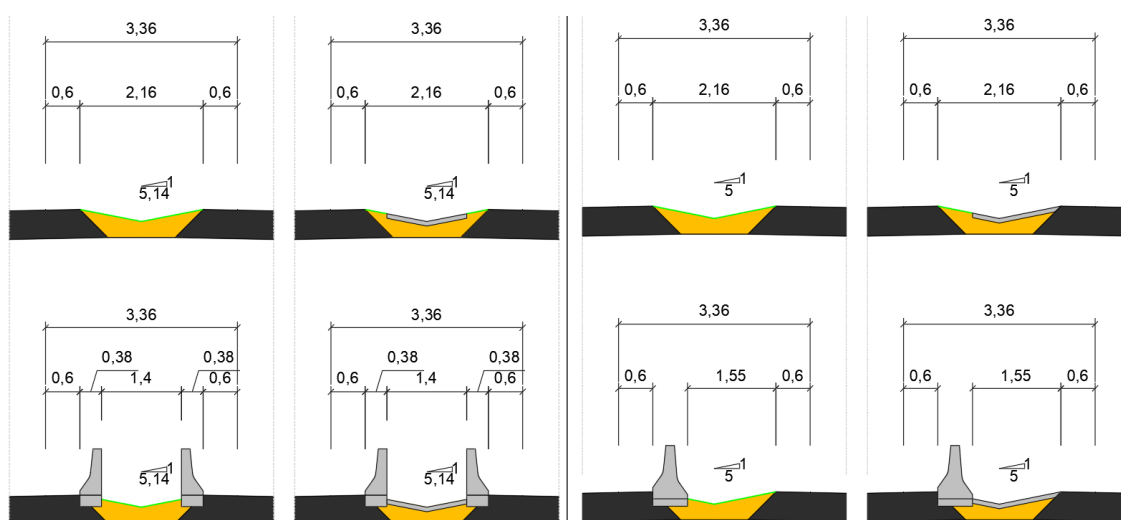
Detalhes sarjetas de canteiro central com e sem barreira.
